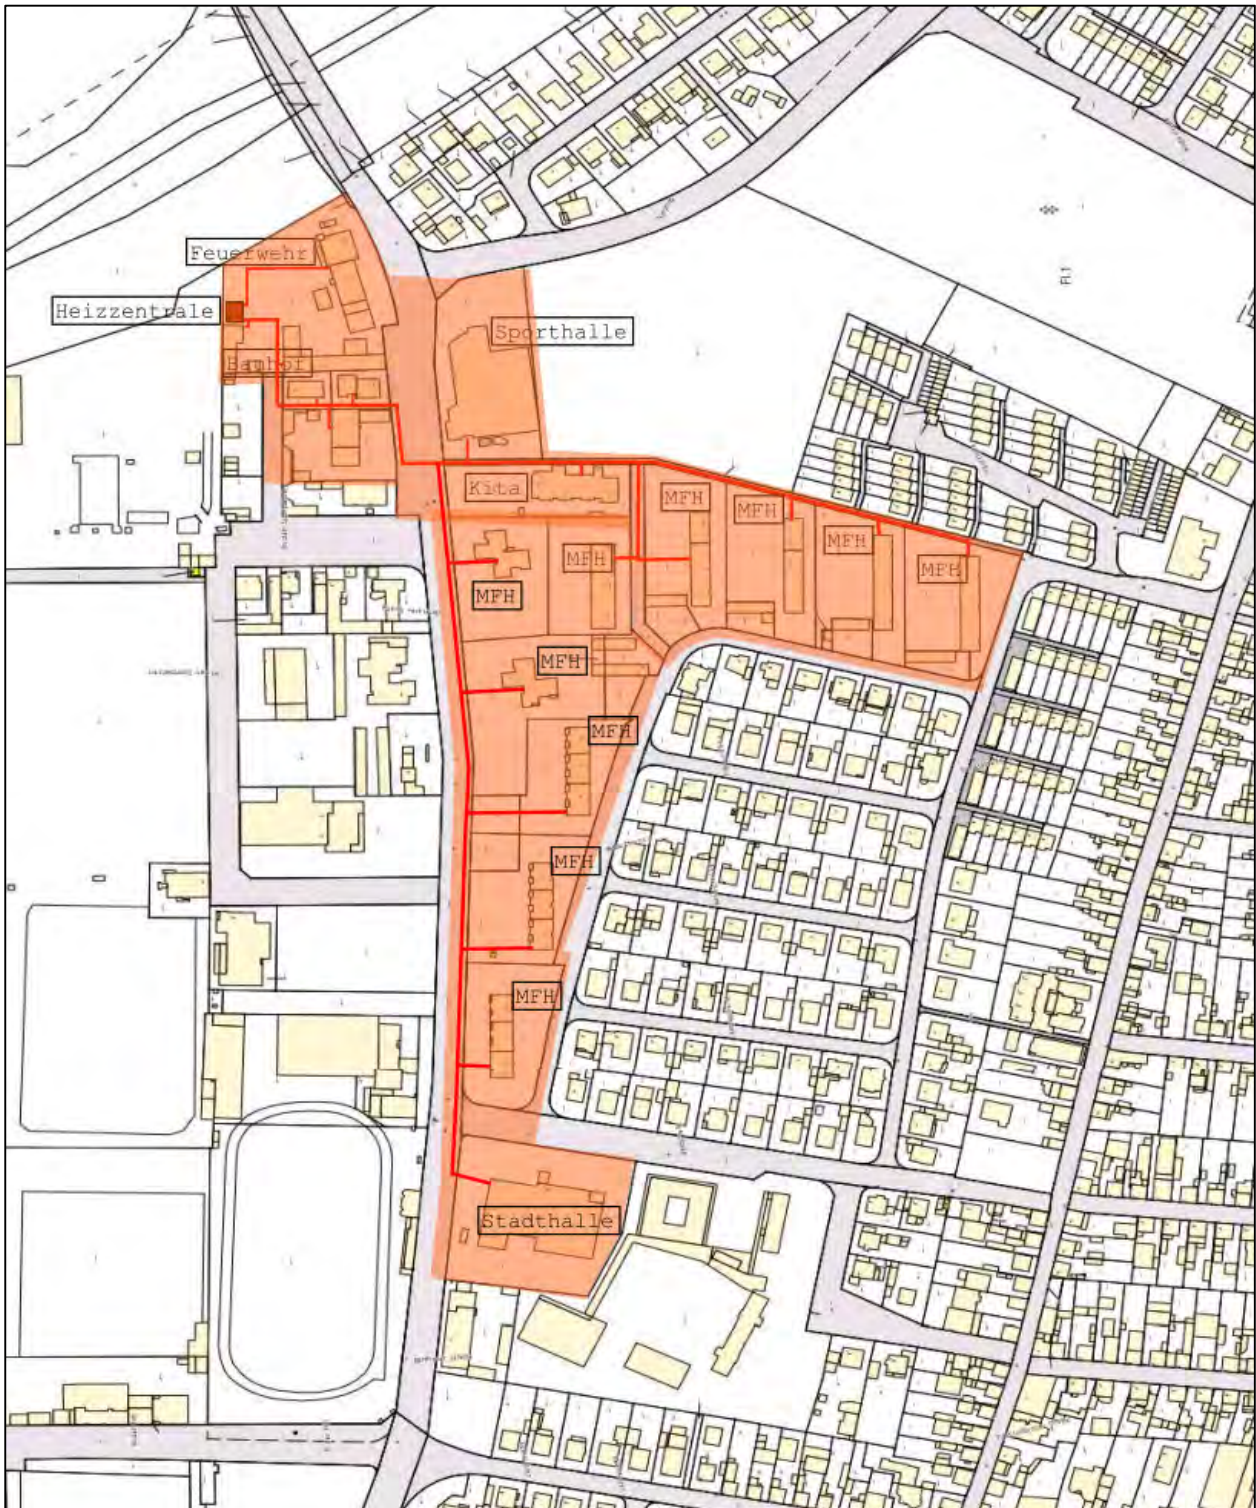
Lageplan Nahwärmenetz Niddastraße – Okrifteler Straße
